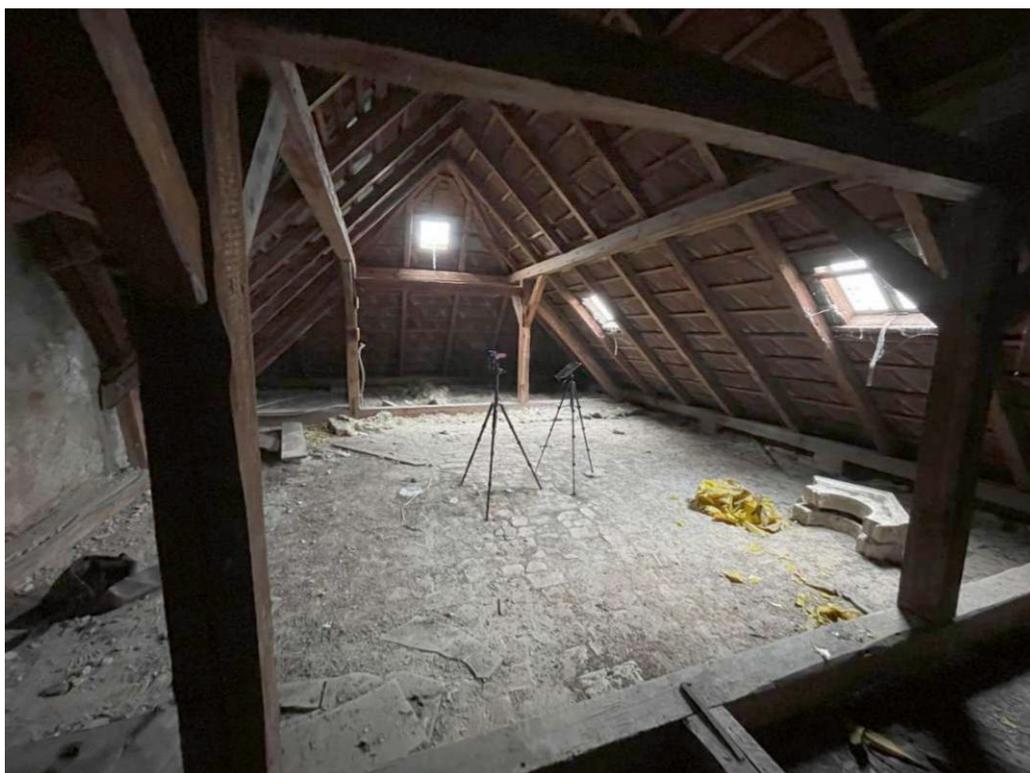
Zugang zu dem Dachboden DB.04- Blick Richtung Süden, 2024
